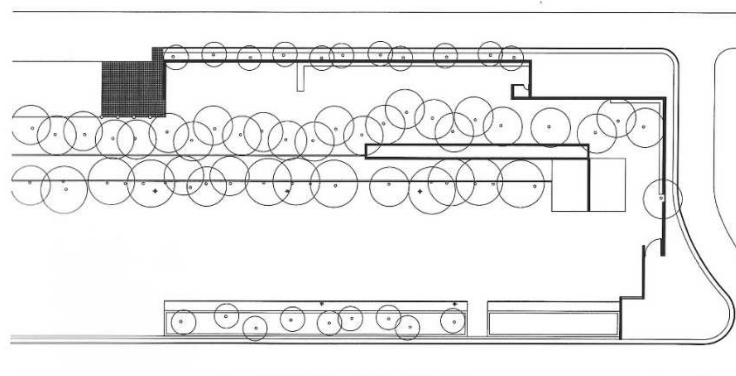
PLANTA DO ESPAÇO– IMAGEM: “BARRAGAN, OBRA COMPLETA”
